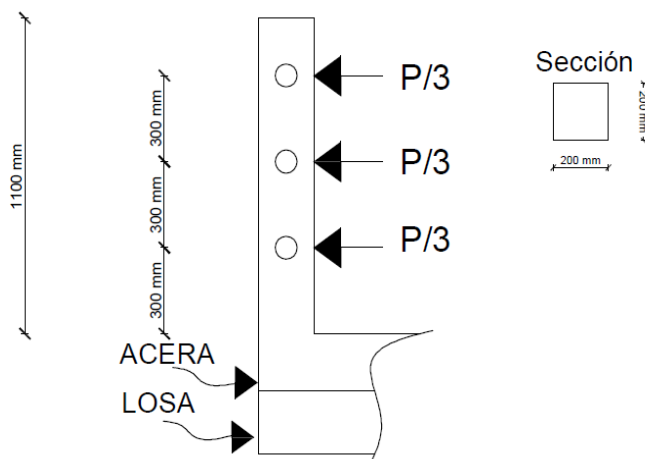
Carga actuante en parapeto y sección transversal. Elaborado por: Autor
